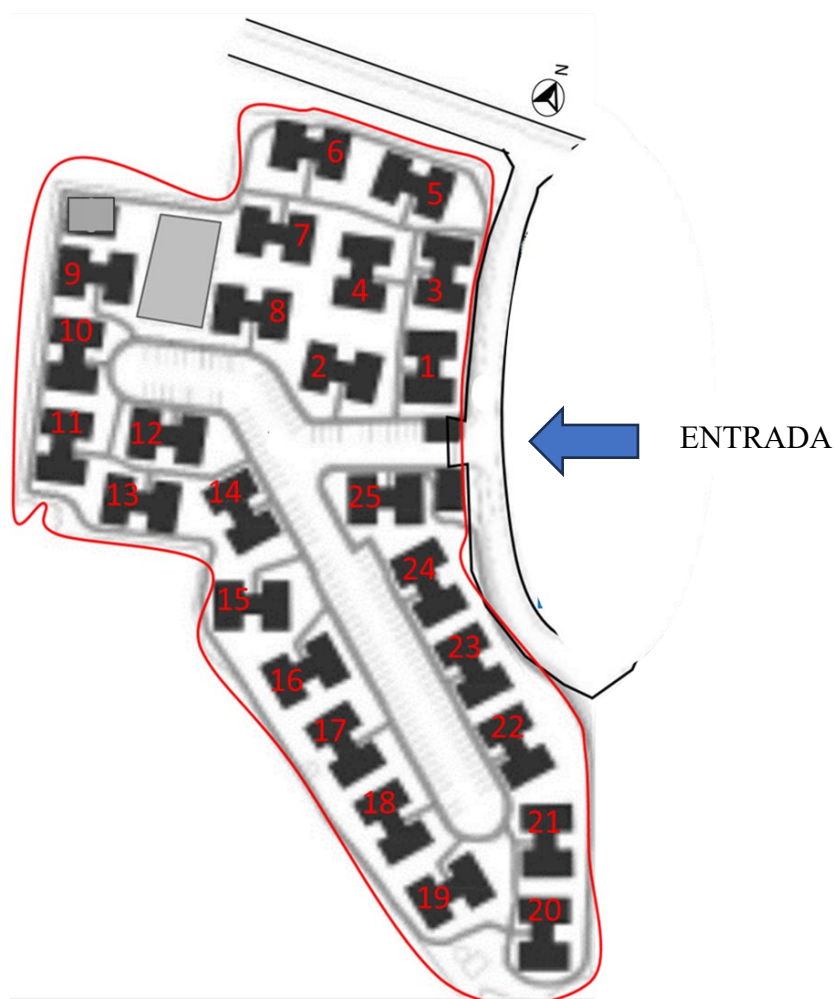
Planta de implantação do Condomínio Ismael Silva – Não tem escala
